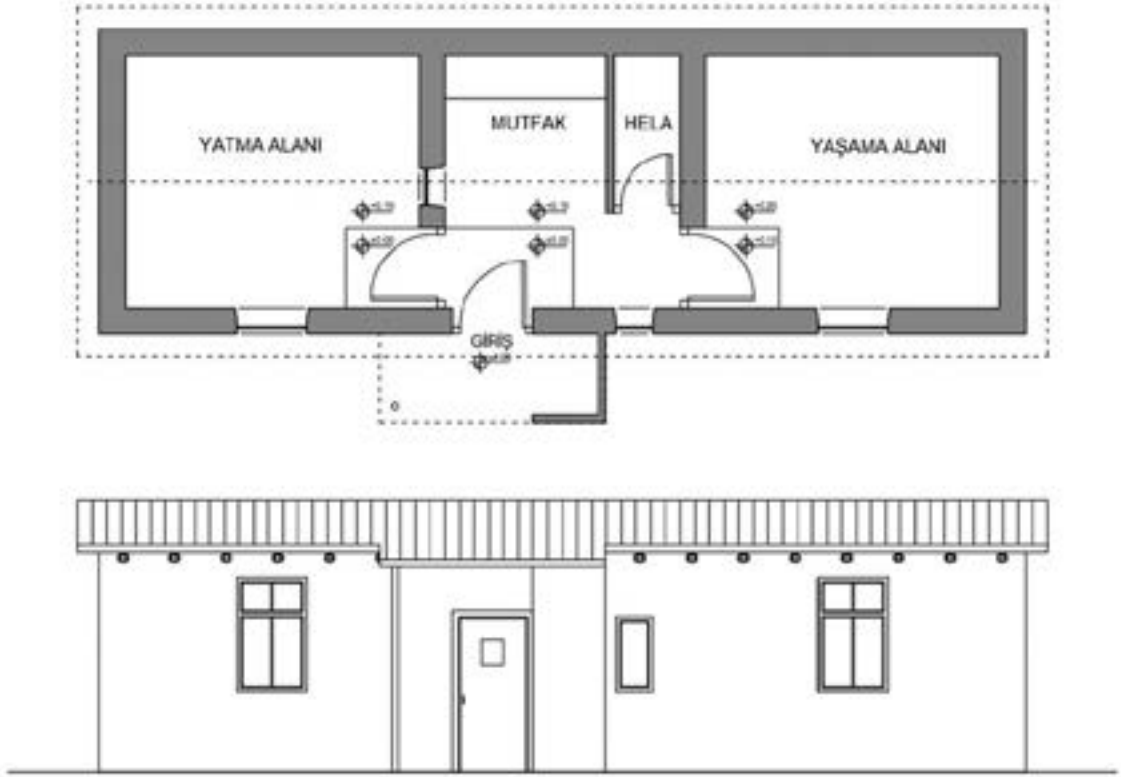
Hükümet Evi Plan Şeması ve Cephe Görünümü
